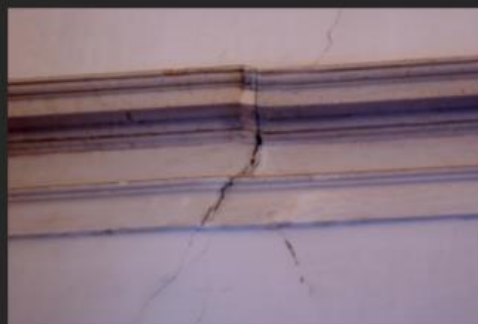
Pormenor: Sala dos armários fradescos, Fissura
